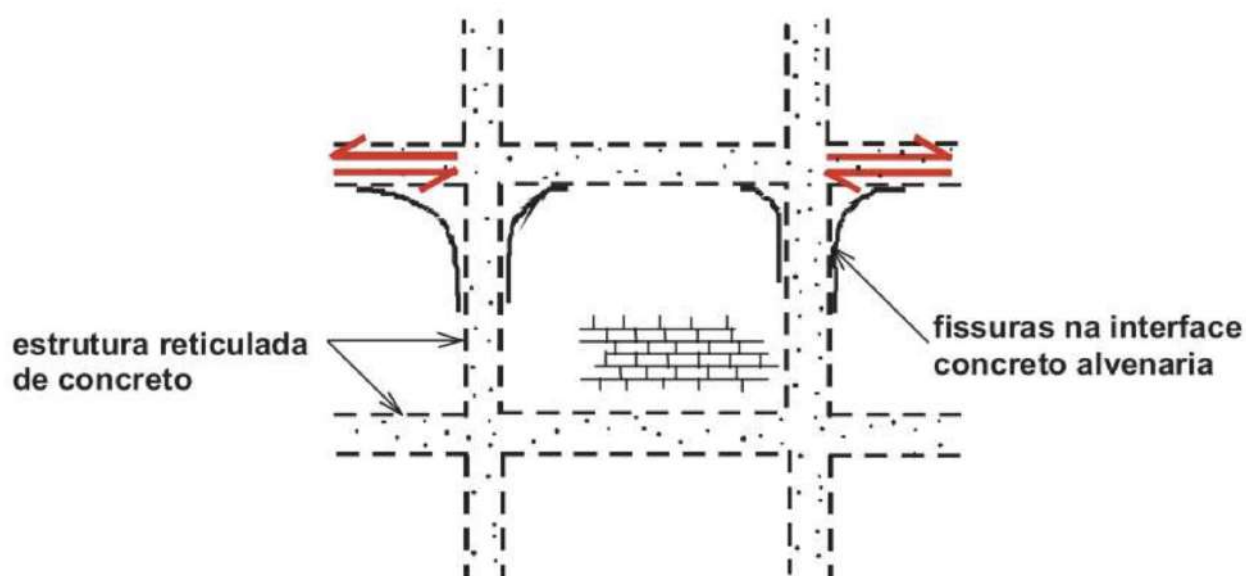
Fissuras no encontro estrutura e alvenaria. Fonte: Thomaz (1989).
